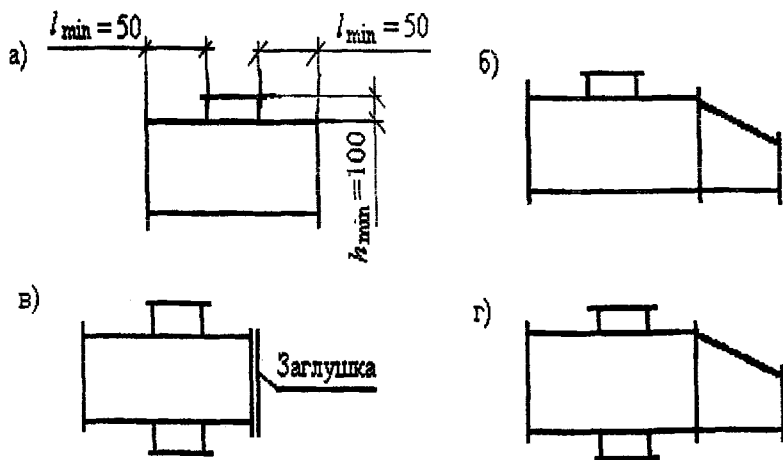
Схемы образования узлов отвлечения прямоугольного сечения:
